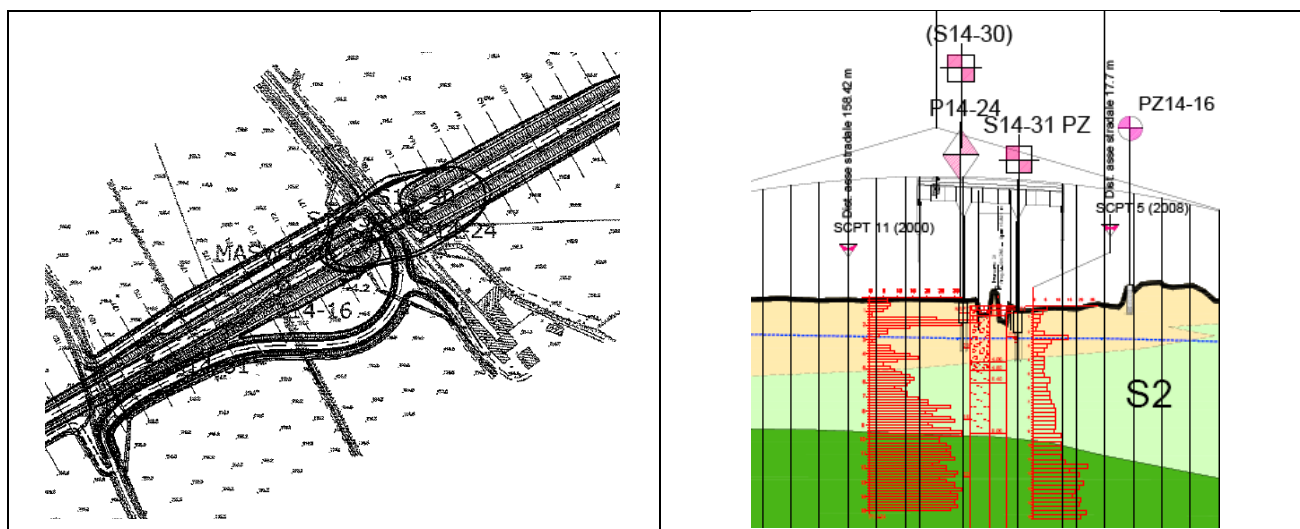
Stralcio planimetrico e stralcio profilo geologico Ponte Roggia Ticinello
